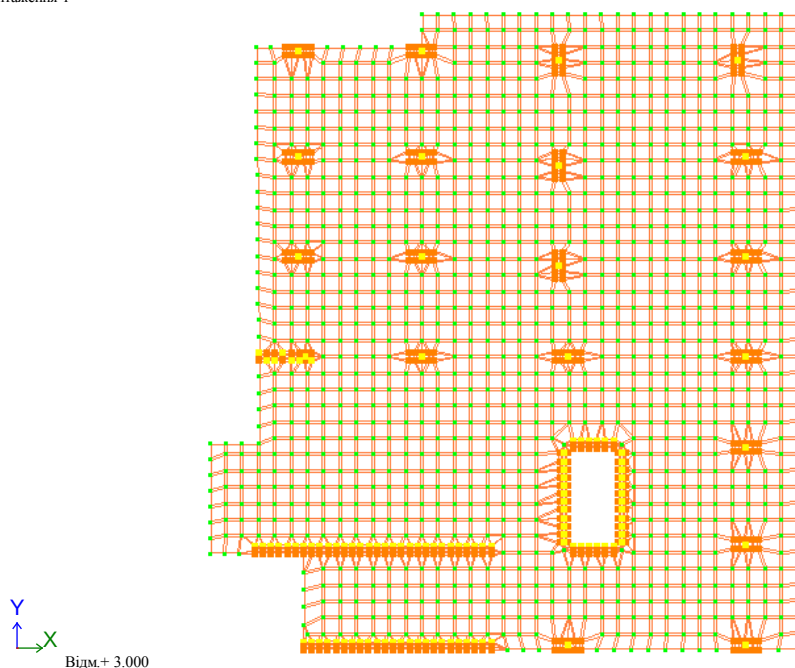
Модель плити перекриття підвального поверху половини будівлі із скінченних елементів
